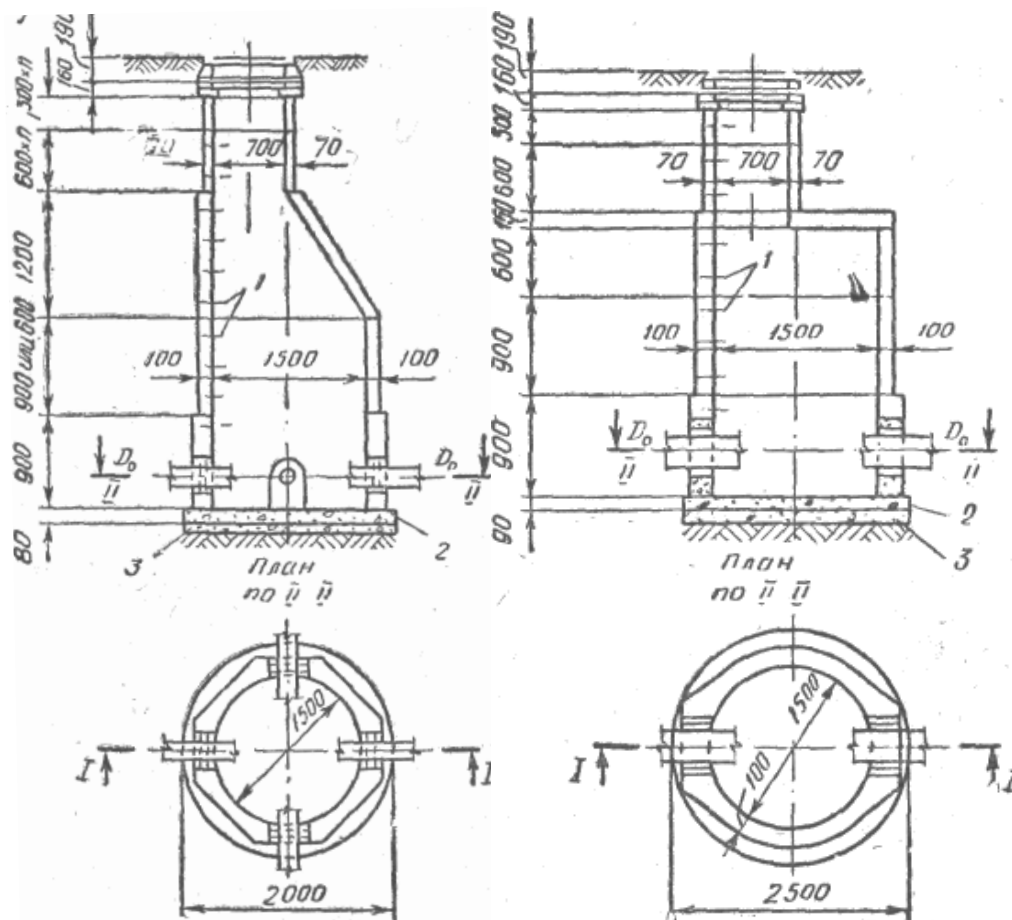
Збірний залізобетонний водопровідний колодязь
